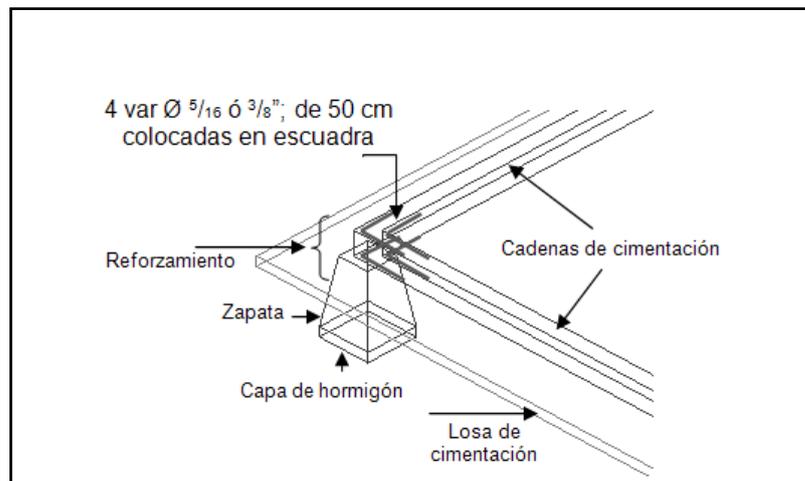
Reforzamiento de las aristas en la cadena de cimentación.
